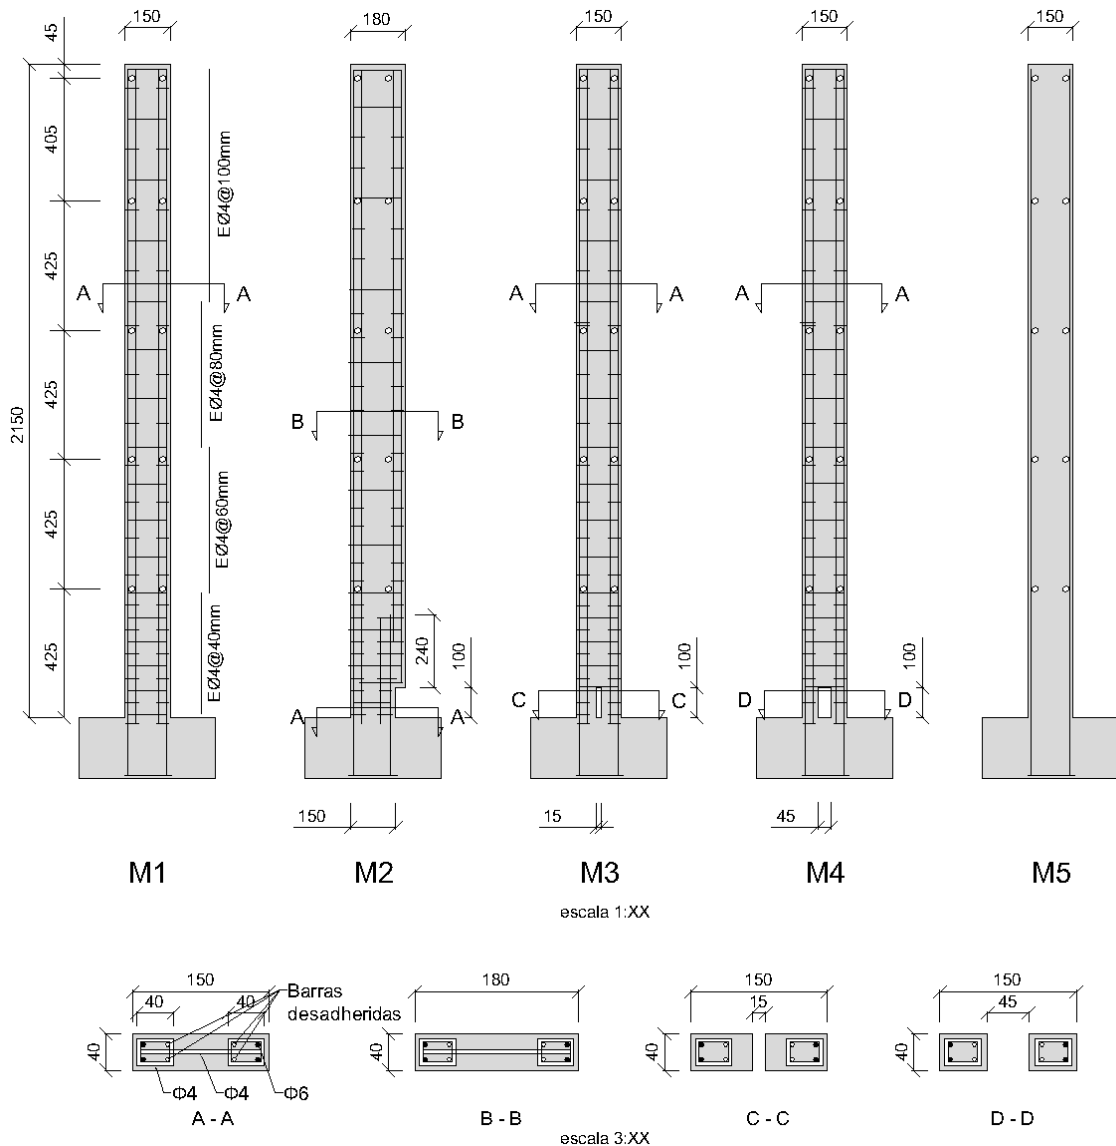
Elevación y Cortes de Sección de refuerzo de las Probetas (dimensiones [mm]).
